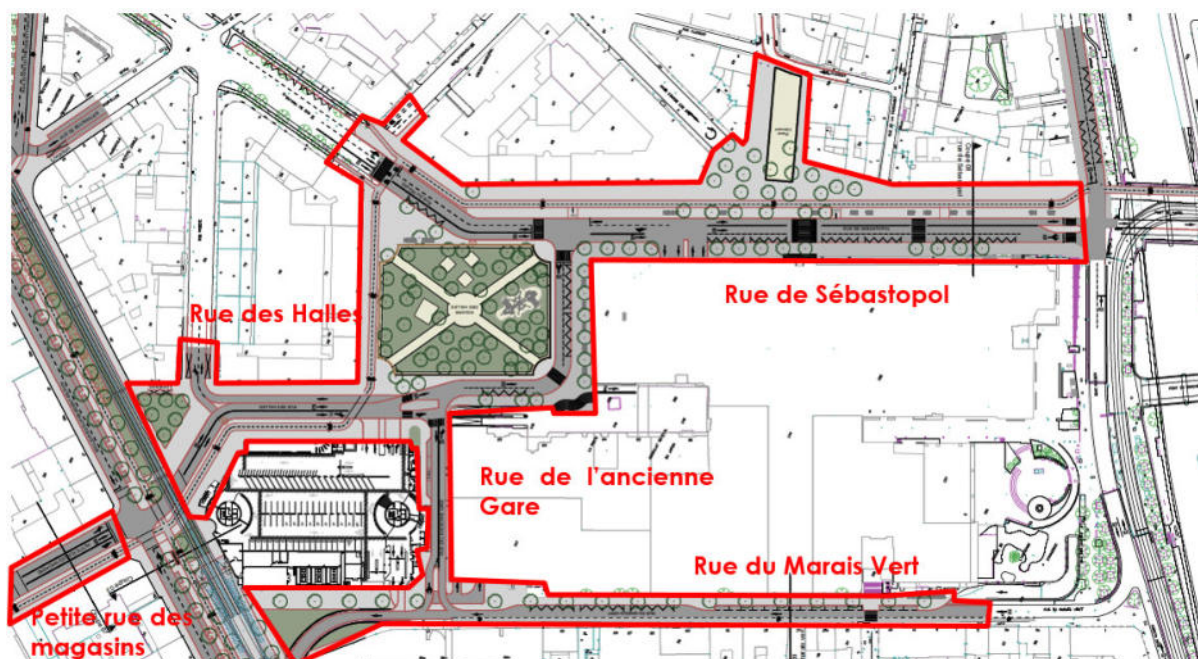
EMPRISE DU PROJET – SECTEUR HALLES
